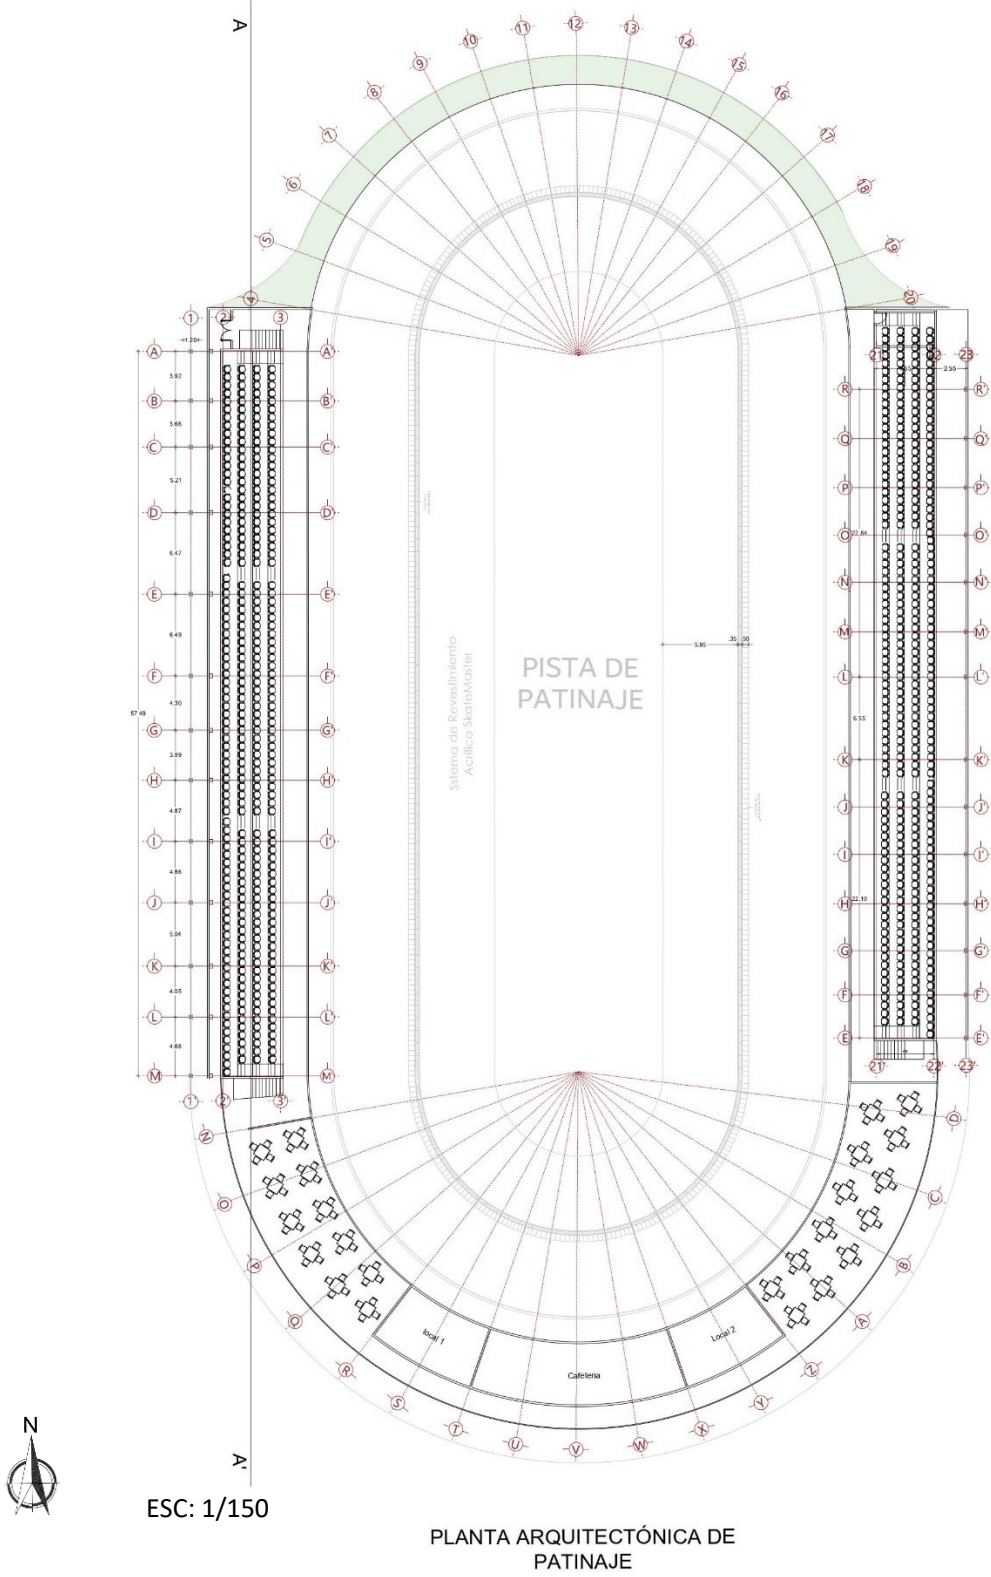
Planta Arquitectónica volumen de Patinaje segundo nivel.
